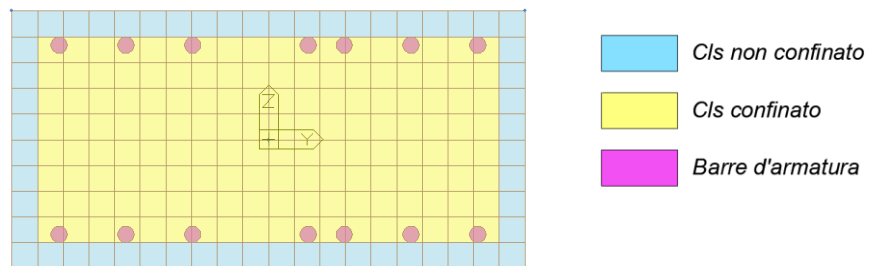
Sezione a fibre TR_T1 (estremità)
